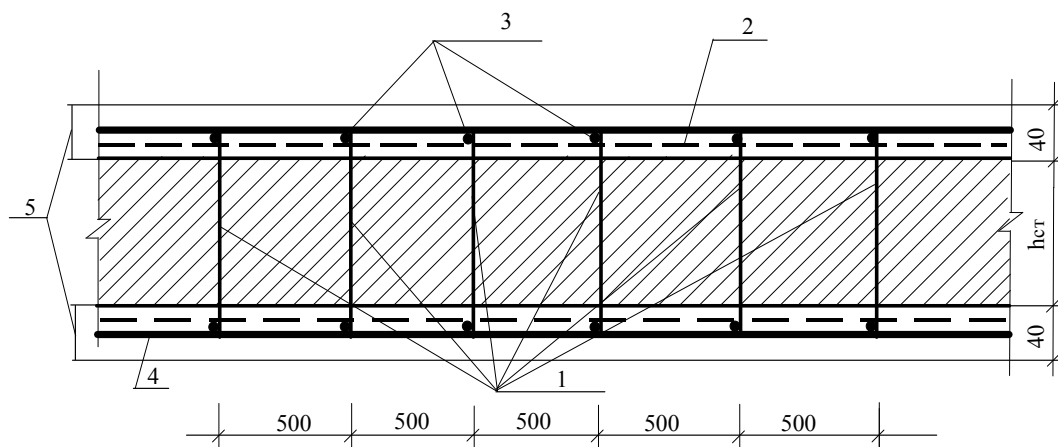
Схема усиления протяженной кирпичной стены, армированной штукатурной обоймой: 1 - поперечные стержни диаметром 16 мм, расположенные через 50 см по длине и через 50-75 см по высоте стены; 2 - стальная сетка из стержней диаметром 4-5 мм с ячейкой 15×15 см; 3 - вертикальные прижимные стержни из круглой стали диаметром 14-16 мм через каждые 50 см; 4 - горизонтальные стержни из круглой стали диаметром 12 мм через каждые 50-75 см по высоте стены; 5 - штукатурный слой толщиной 40 мм
